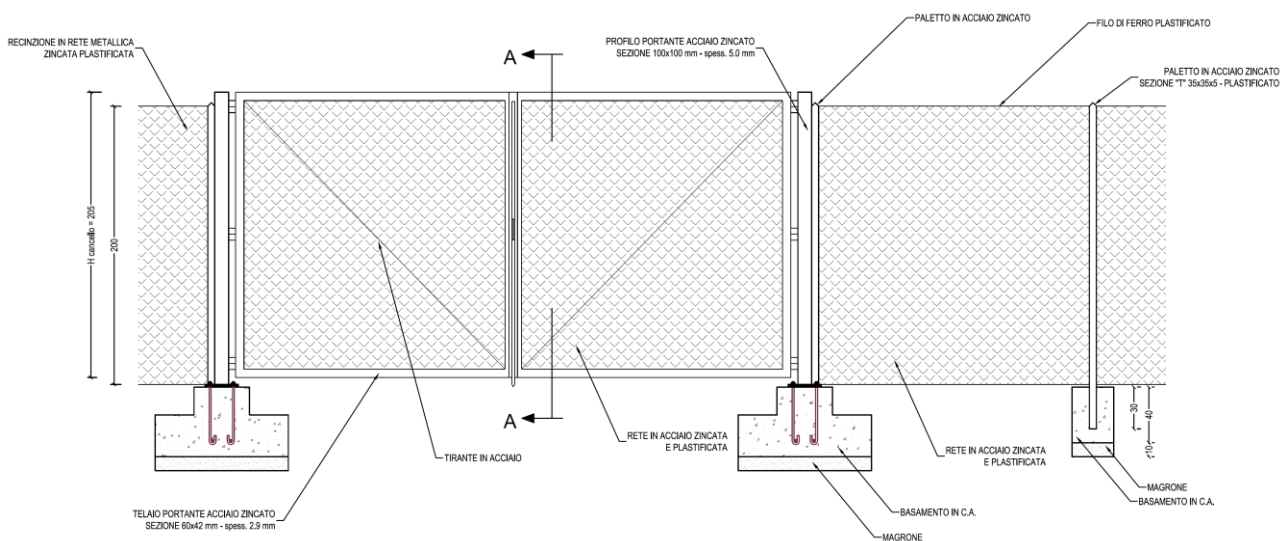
Prospetto della recinzione e del cancello carraio in progetto
